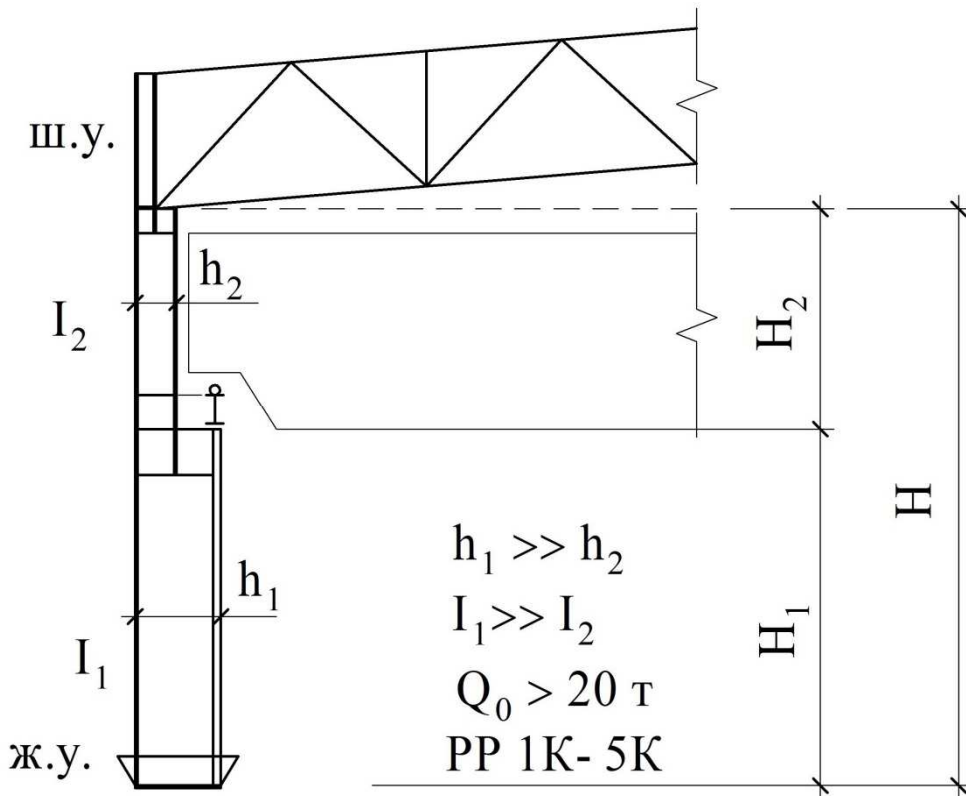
, а – Конструктивная схема многопролетной поперечной рамы со ступенчатыми колоннами: верхние узлы - шарнирные, нижние – жесткие
